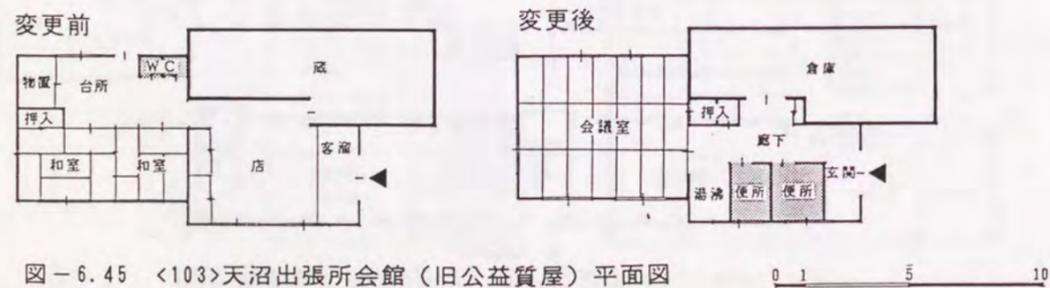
〈103〉天沼出張所会館(旧公益質屋)平面図
